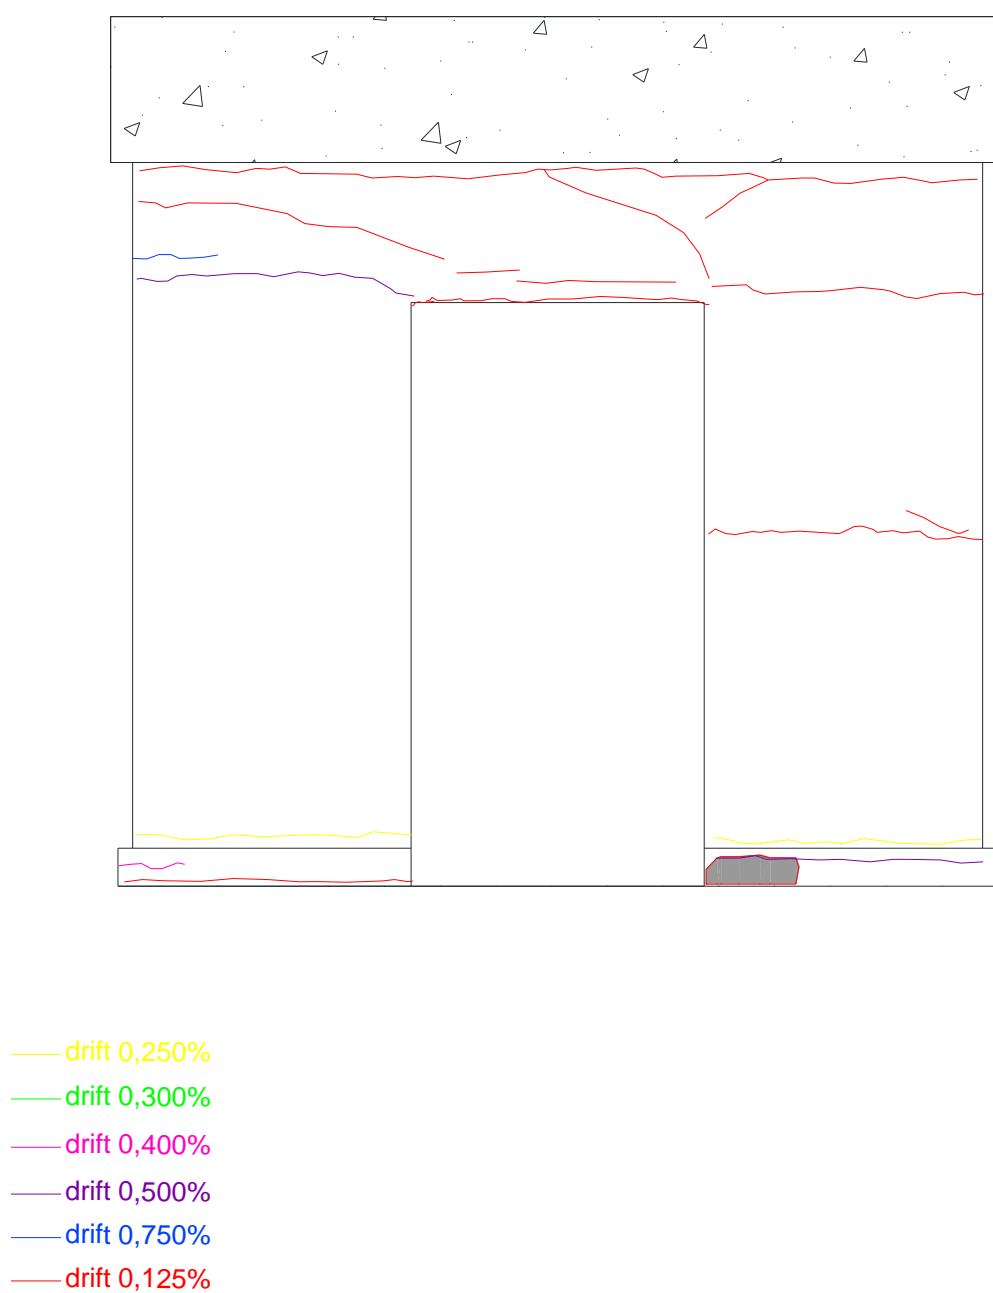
Mapa de pormenor de danos do modelo reforçado: Fachada Este
